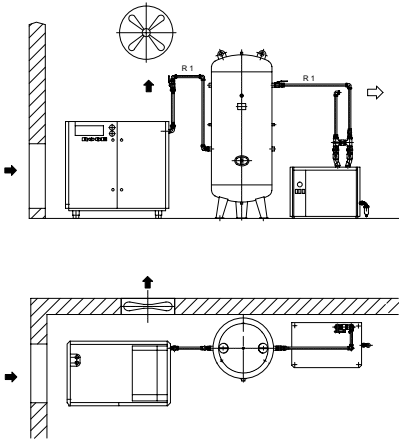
Kompressorstation mit Schraubenkompressor, Kälte-Drucklufttrockner, Druckluftbehälter
